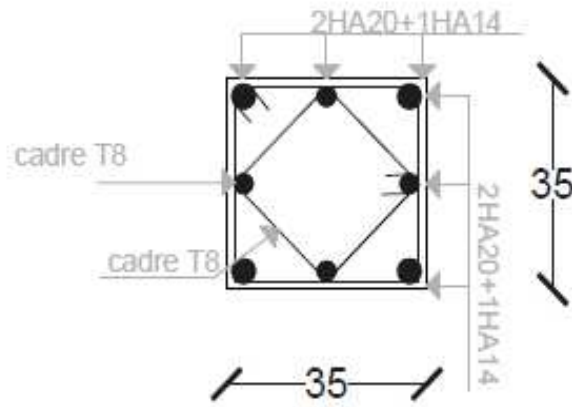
Schéma de ferrailage de poteaux carré 35x35
